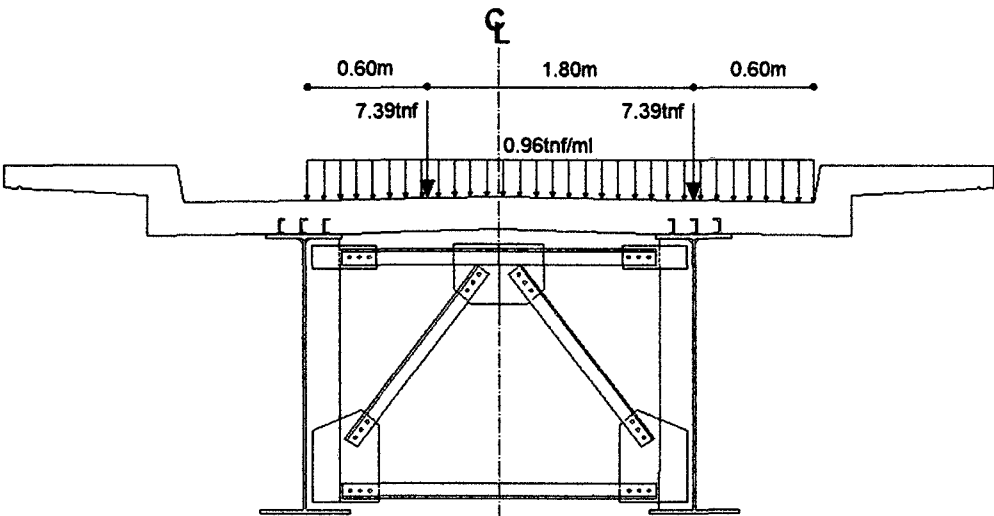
Ubicación de la carga móvil excéntrica sobre la viga diafragma - Primer y Segundo Tramo.
